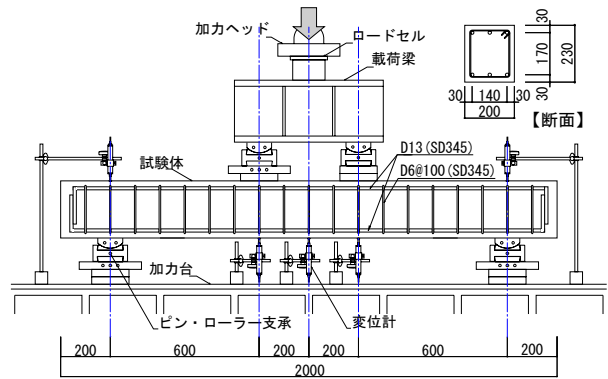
RC 曲げ試験の荷重概要図 (単位 mm)
